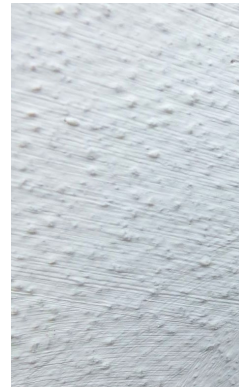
Fassadeninstandsetzung eines Stallgebäudes mit Kalkputz – freskal mit Heißkalkanstrich (Oberflächendetail rechts)
